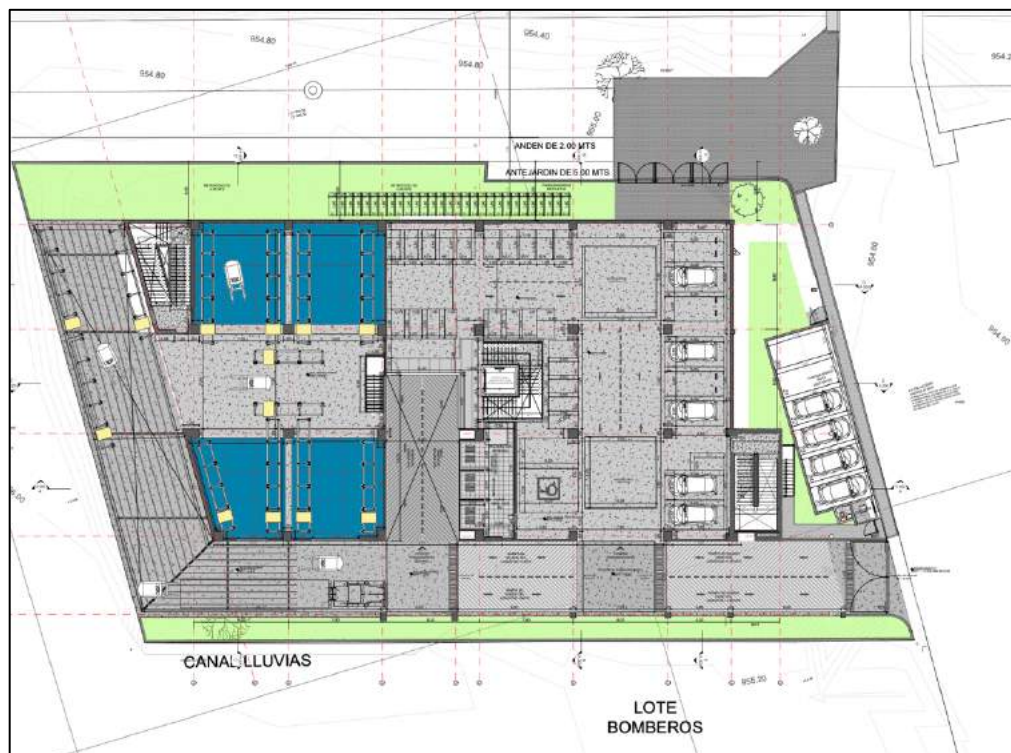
Planta de Distribución del primer nivel del CIGRED. Tomado de: 026-A-101-PLANTA GENERAL PRIMER PISO- PLANTA GENERAL PRIMER PISO
